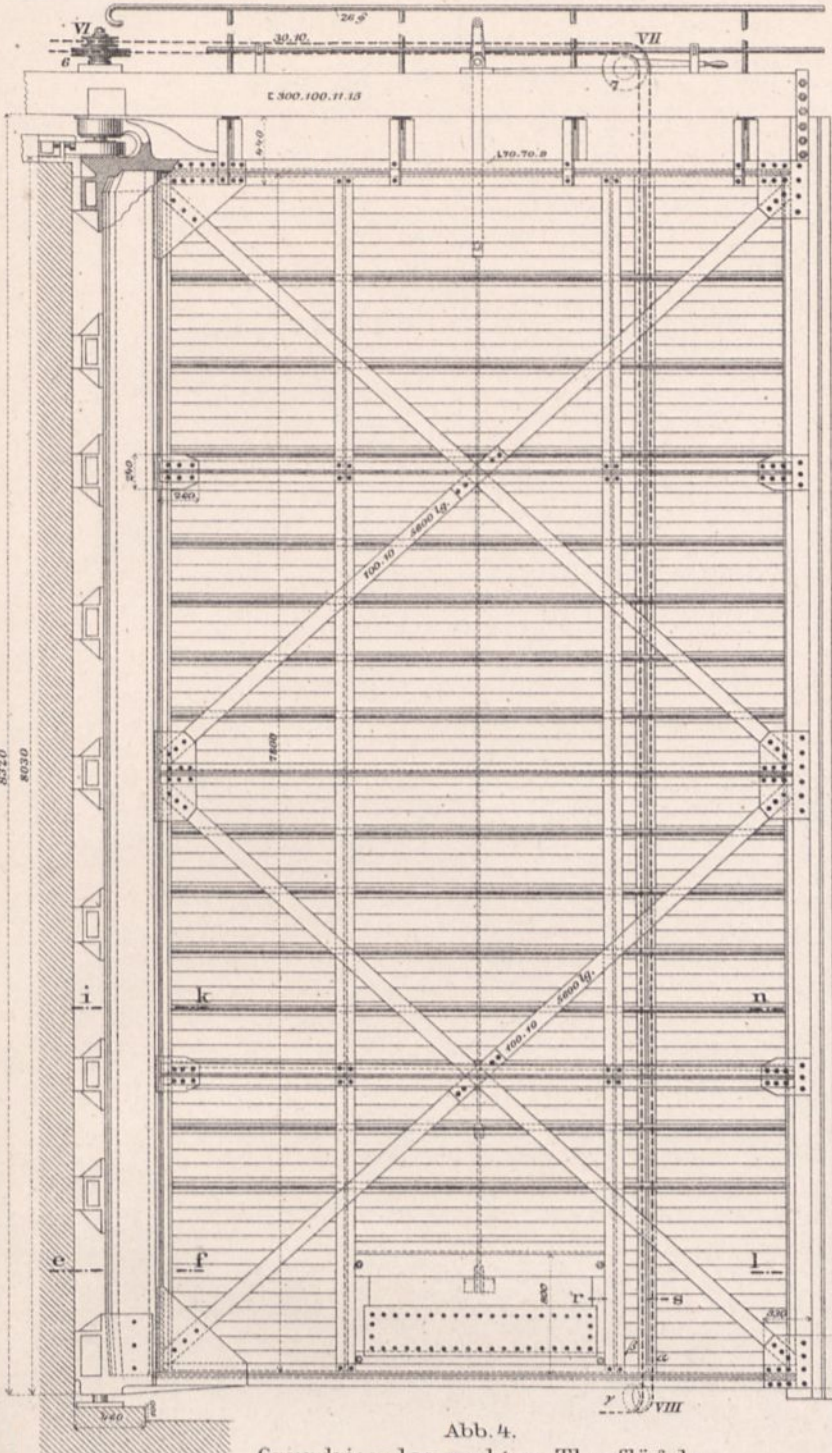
Grundriss des rechten Thorflügels.
